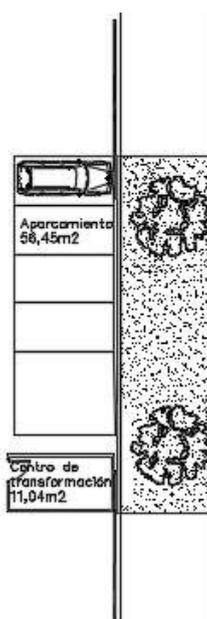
Aparcamiento entrada nave. Fuente: Elaboración propia
